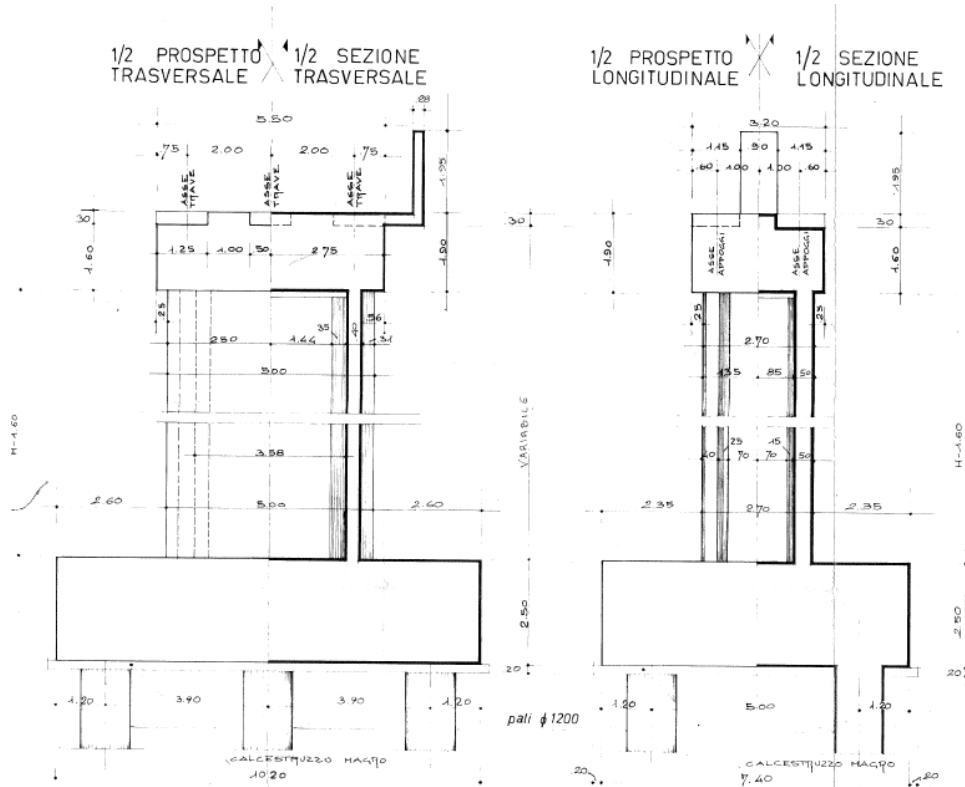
Prospetto Longitudinale e Trasversale Pila
